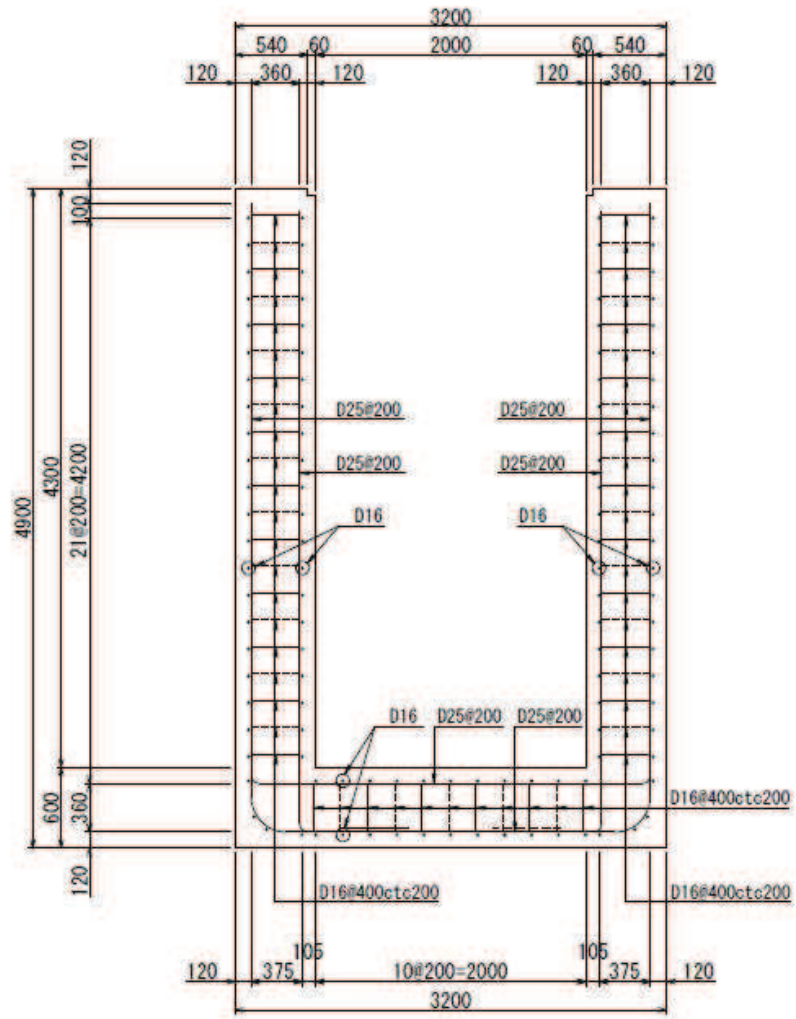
集水ピットの概略配筋図 (単位 : mm)
